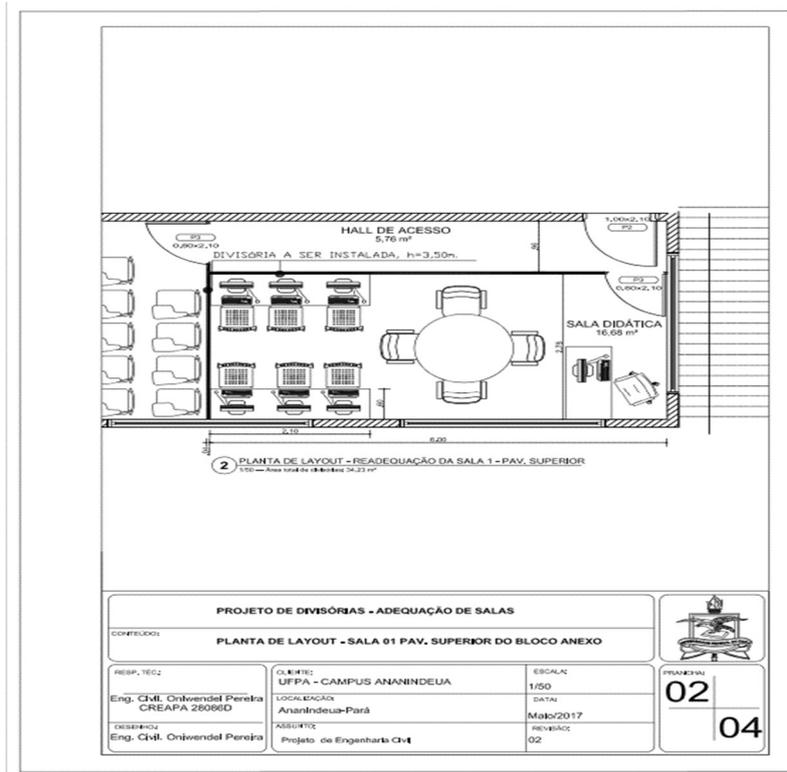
Planta baixa de implantação da sala didática do PCNA, no bloco anexo.
